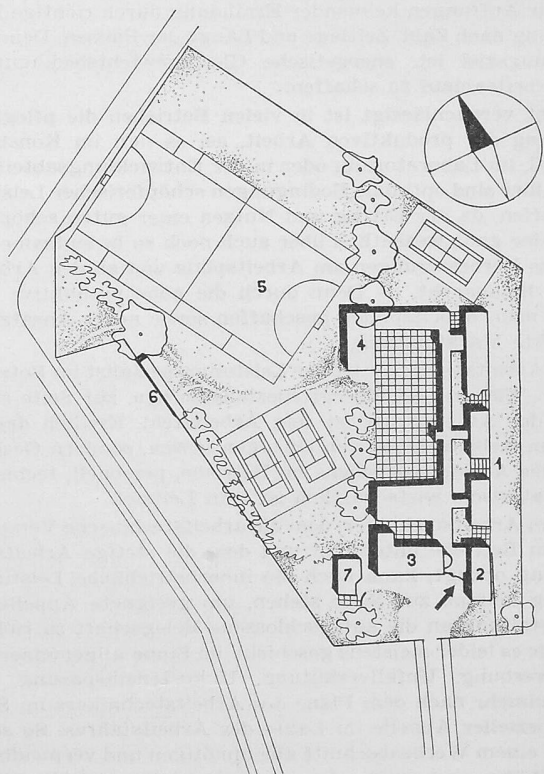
Schule in Richmond, Lageplan 1 : 2500
